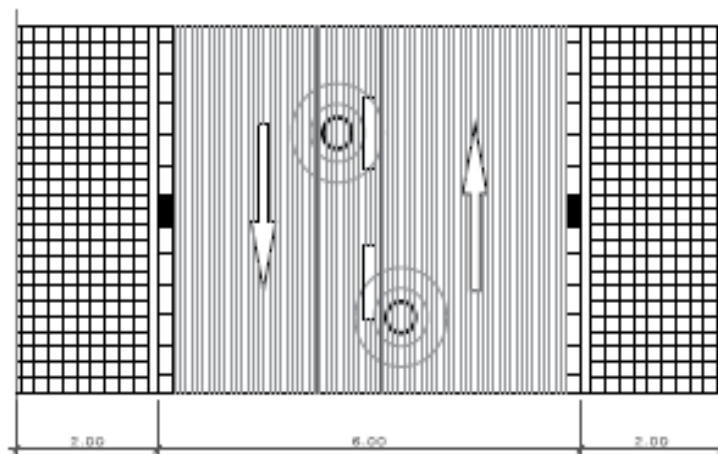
Planta de vial interior del sector Pego Golf.
